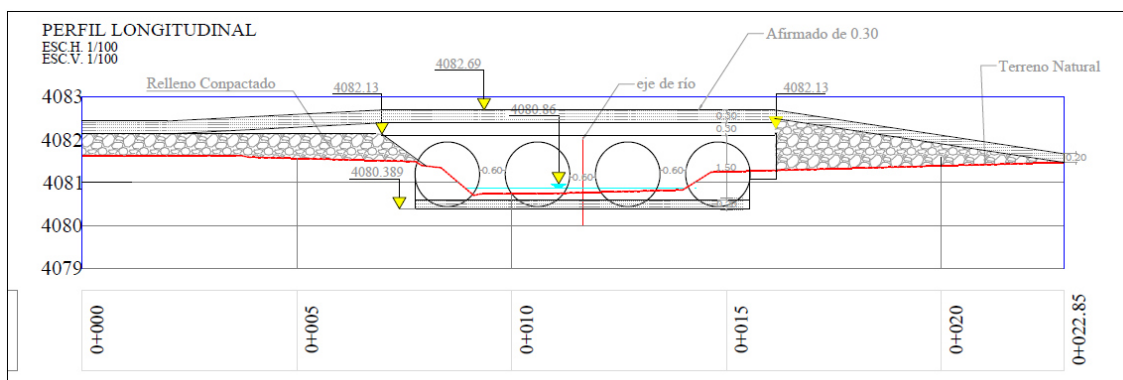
Detalle de la alcantarilla del puente N° 02
